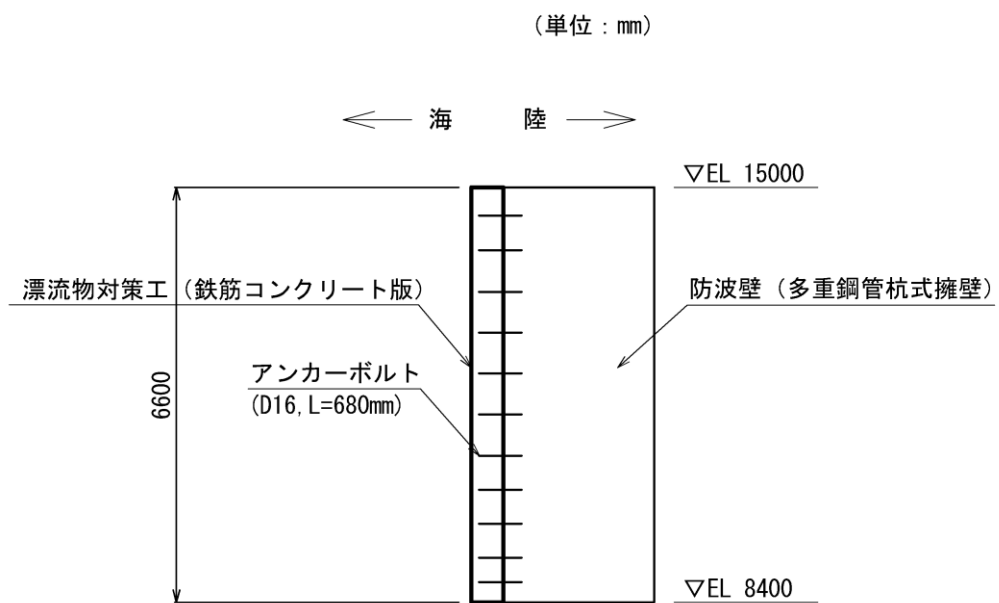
(2) 漂流物対策工 (鉄筋コンクリート版) のアンカーボルト配置図 (断面図)
